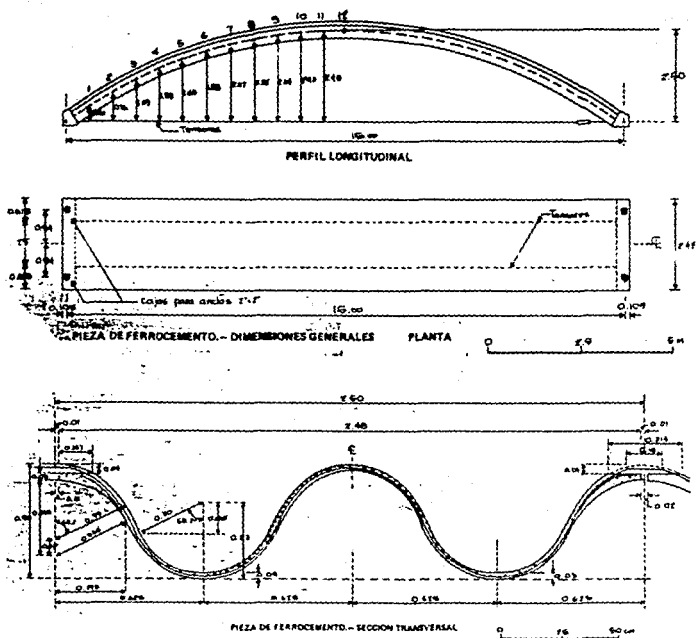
Arco de FERROCEMENTO construido en la UNAM.
